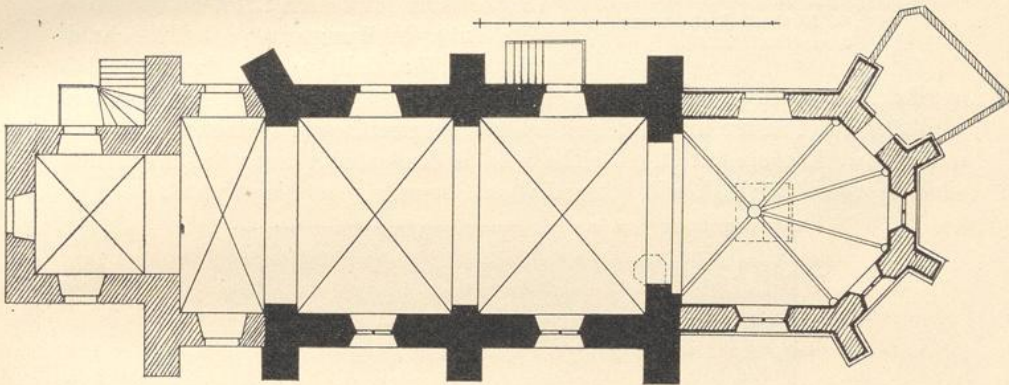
Kirche in Barkhausen: Grundriß (1:250).
